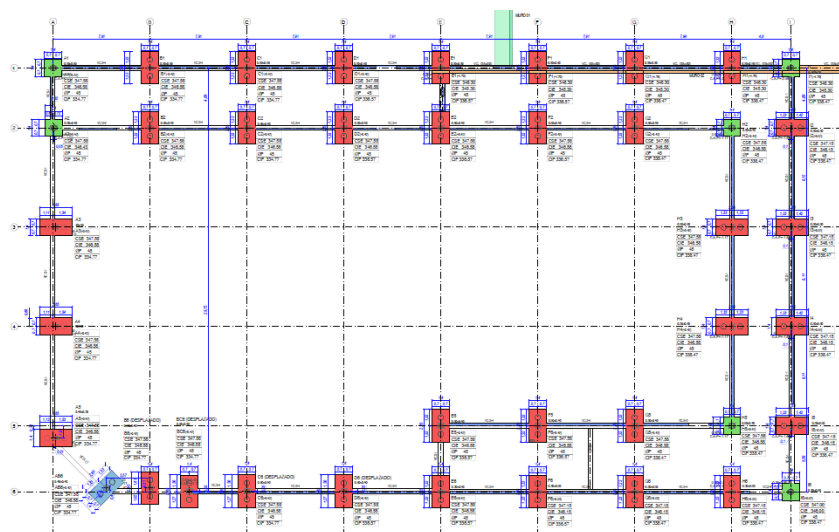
Vista en planta de cimentación, tipologías de encepado
